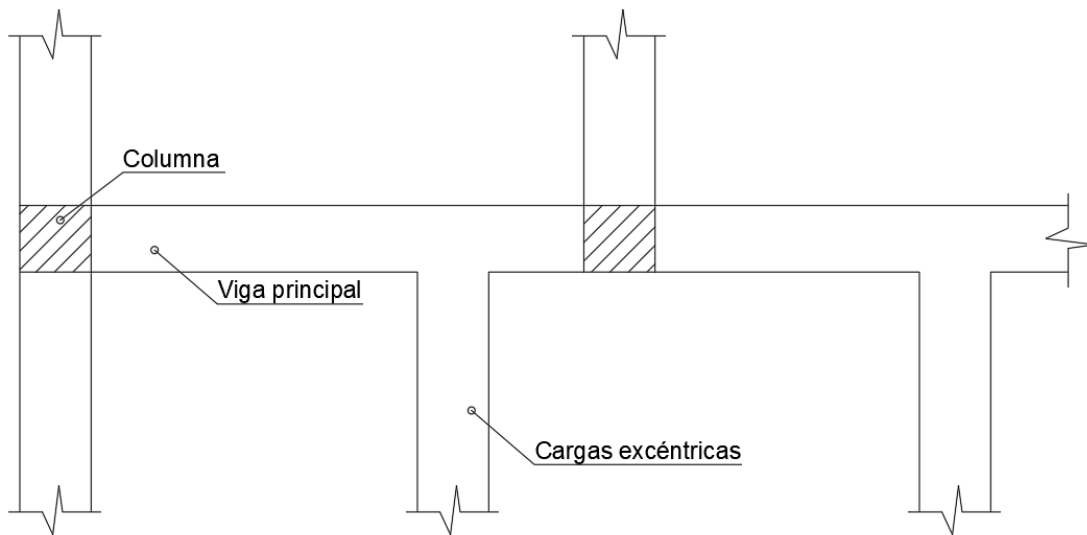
Vista en planta – Cargas excéntricas (Diseño de concreto reforzado pag. 463 McCormac & Brown, 2011).
